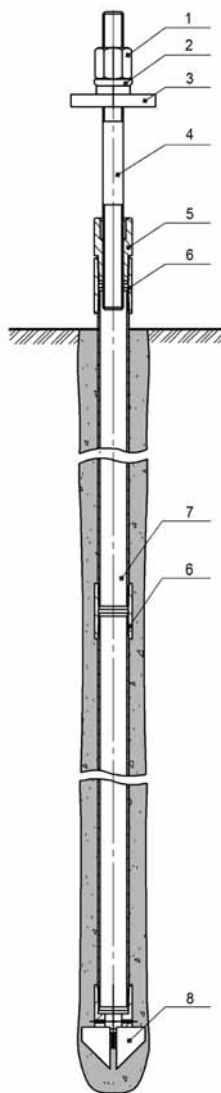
Конструкция анкерной сваи «Атлант»: 1 – гайка; 2 – шайба; 3 – пластина; 4 – шпилька; 5 – переход; 6 – муфта; 7 – труба; 8 – долото буровое
